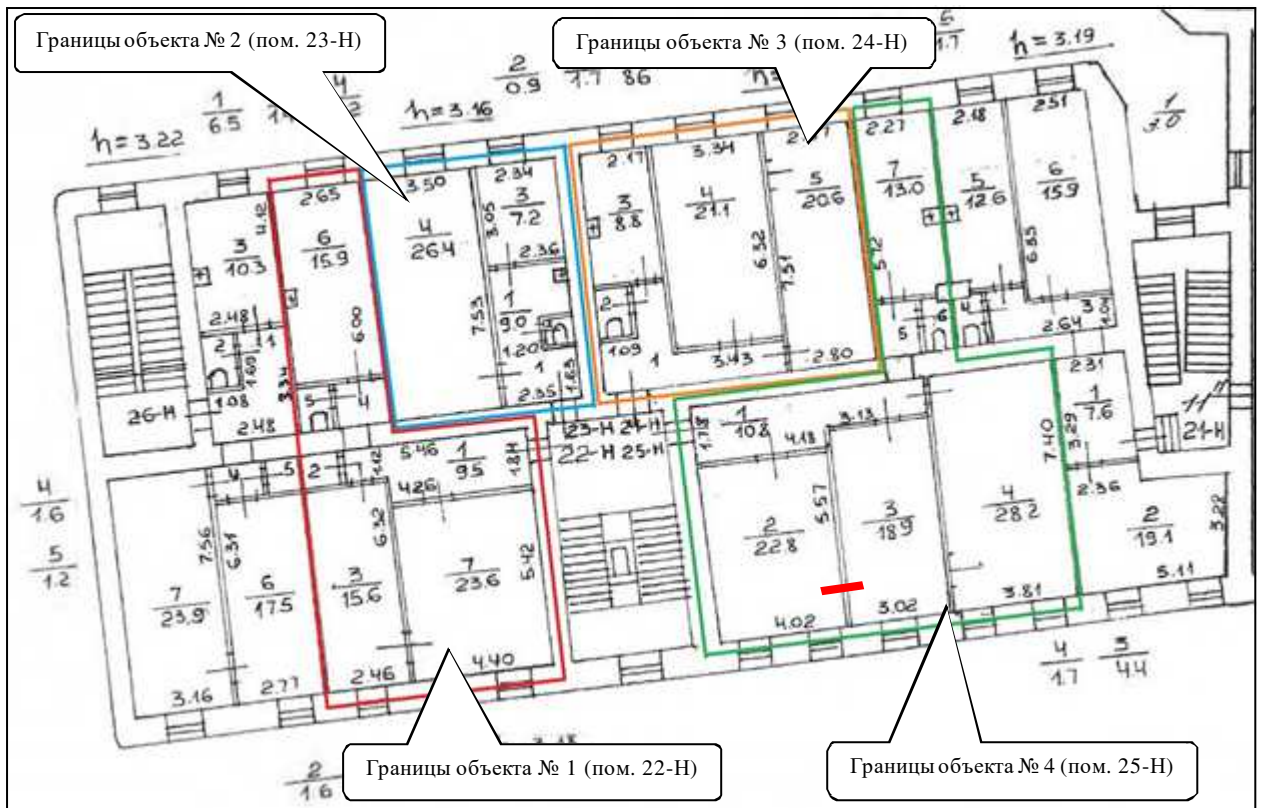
План этажа с указанием границ рассматриваемых помещений с учетом перепланировок
